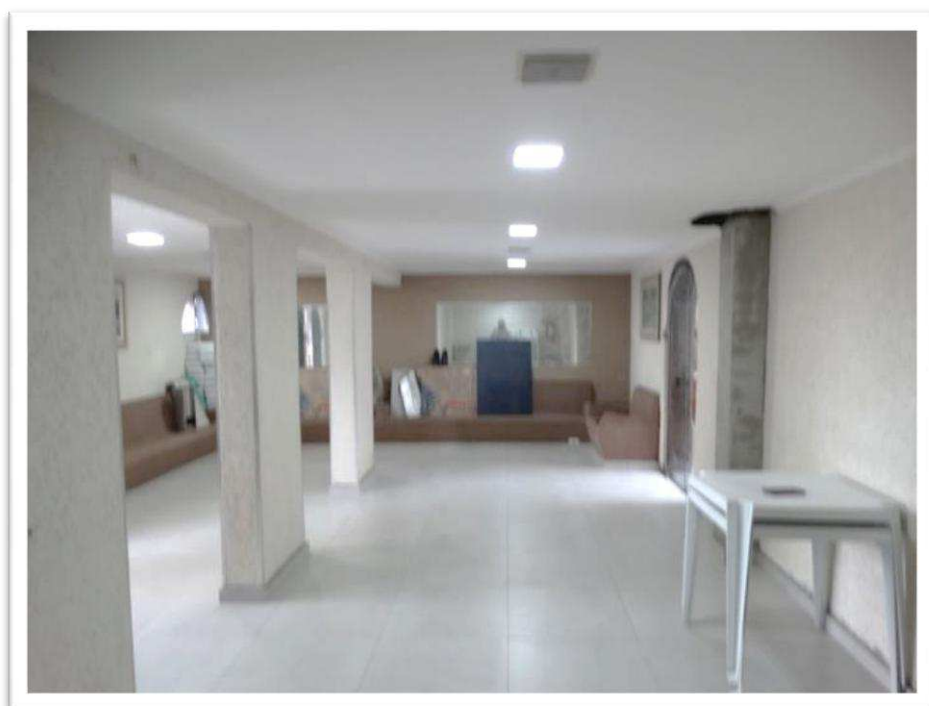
Vista parcial do salão de festas no pavimento térreo do bloco 17.
